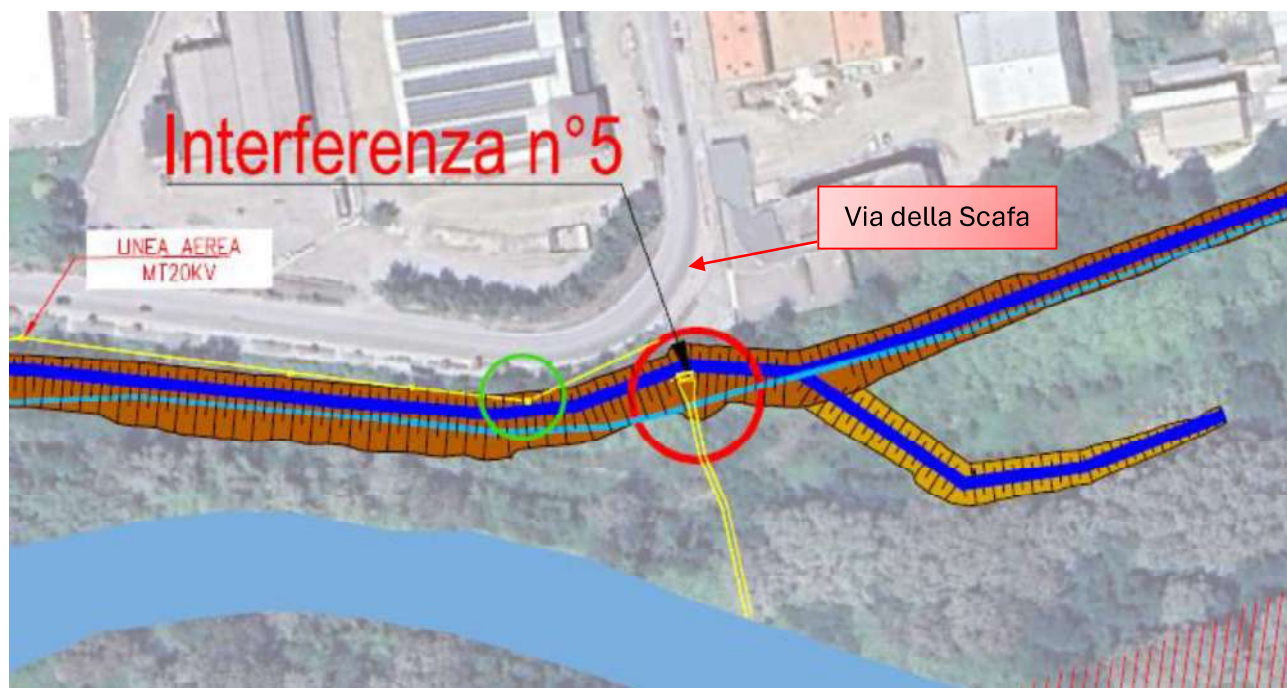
Stralcio planimetrico con ubicazione dello scarico nei pressi di via Scafa
